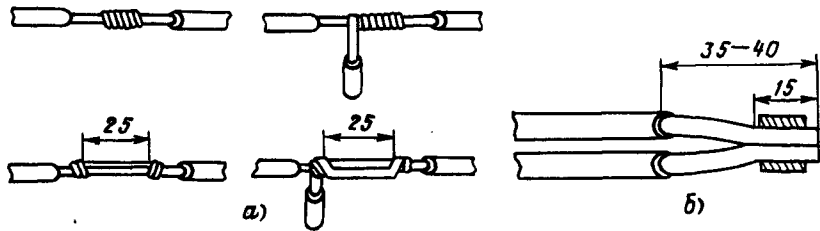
Соединение жил проводов и кабелей перед пайкой:
